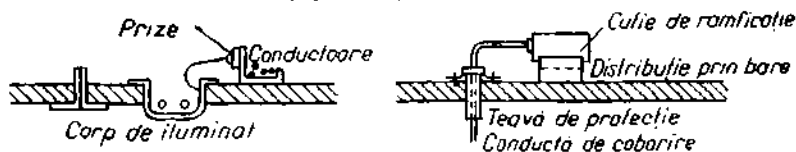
Exemple de execuție pentru plafon fals vizibil
